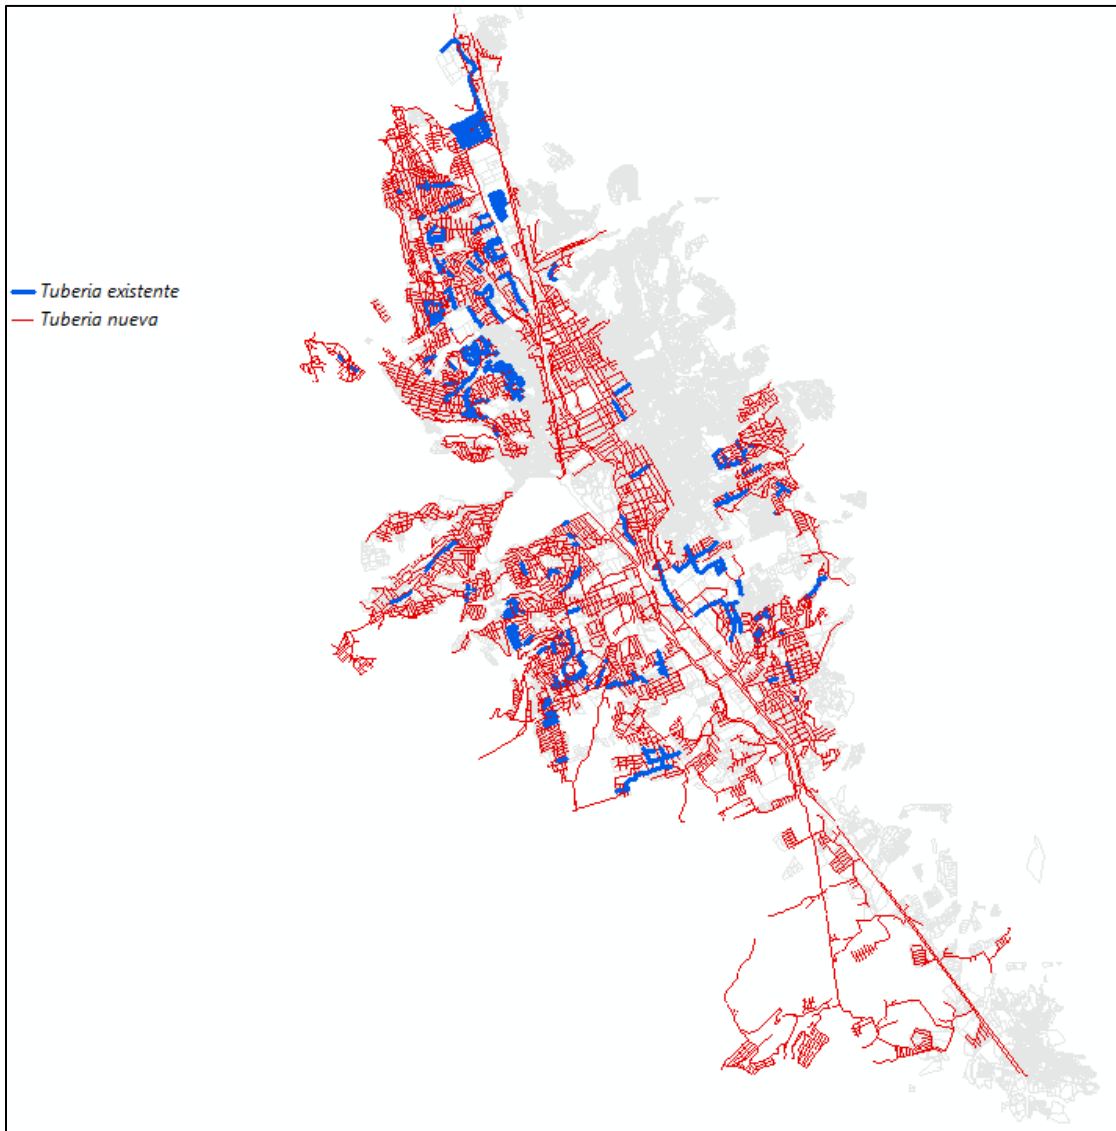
Tubería existente y nueva considerada en la sectorización
